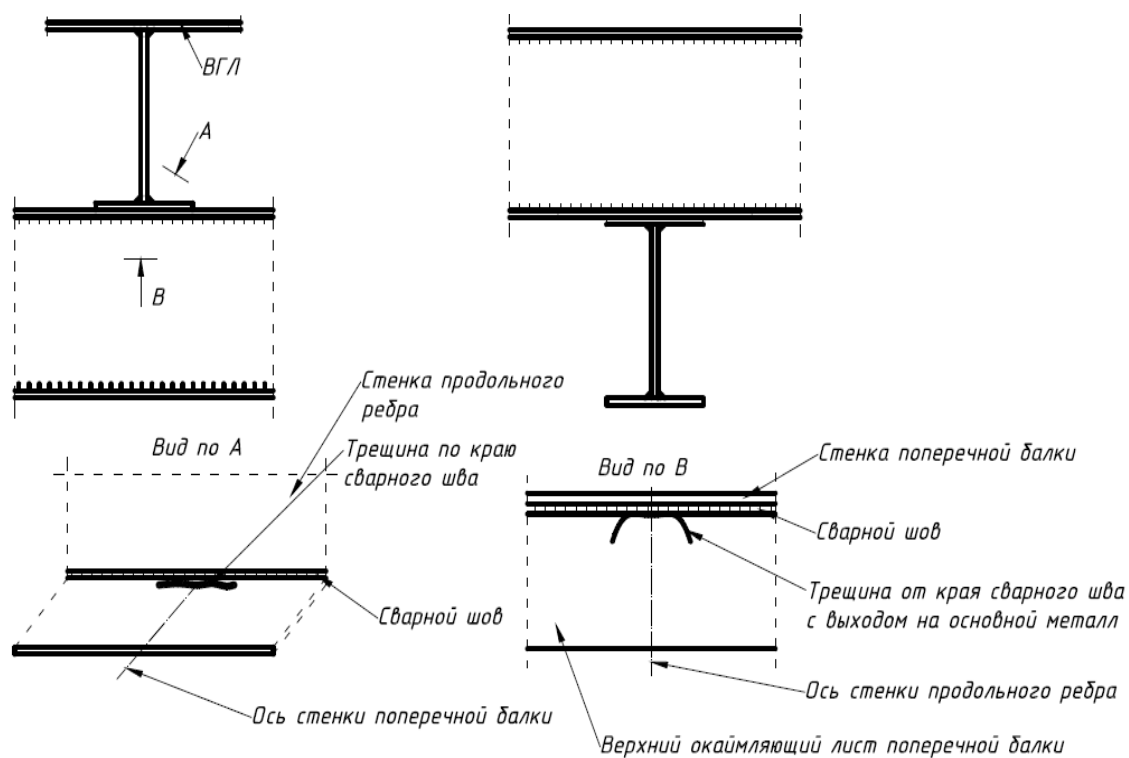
Усталостные трещины, образующиеся в узлах опирания продольных ребер жесткости ортотропной плиты на поперечные балки
